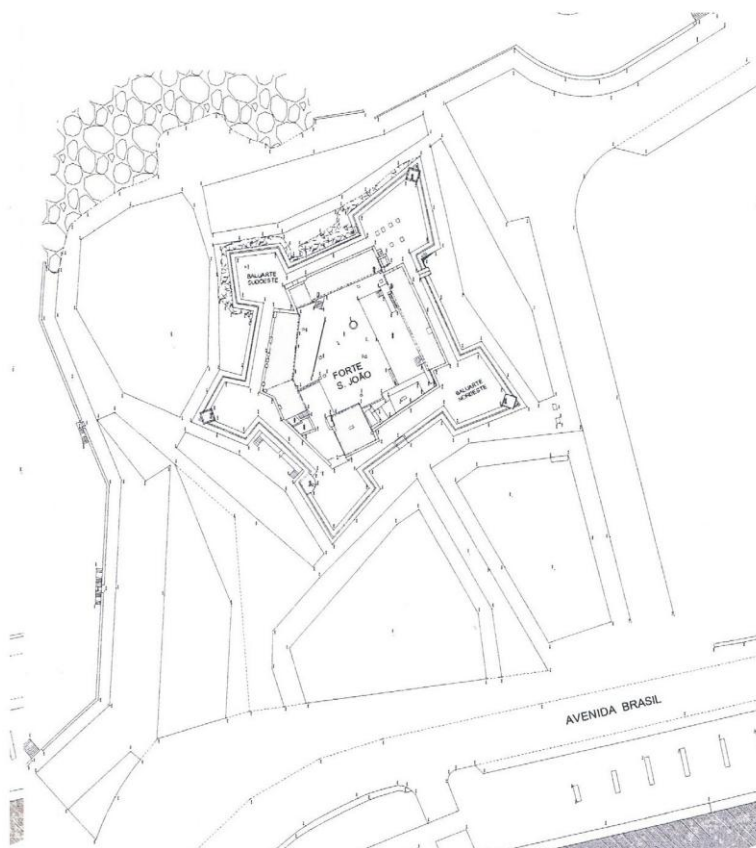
Planta do Forte de S. João. Situação antes da intervenção.
